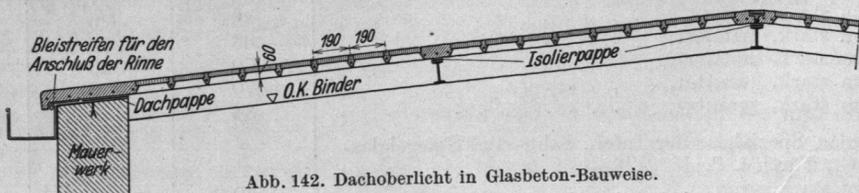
Dachoberlicht in Glasbeton-Bauweise.
